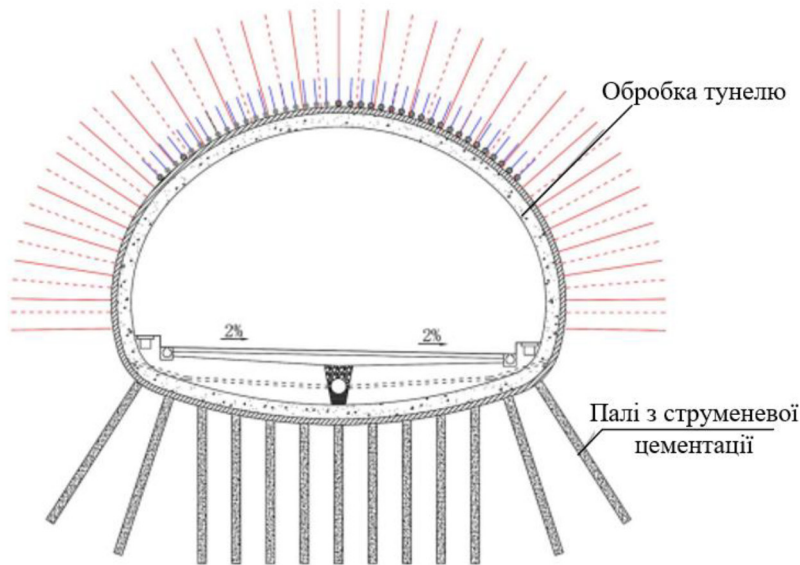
Схема зміцнення лесоподібних ґрунтів основи тунелю (м. Ланьчжоу, провінція Ганьсу, Китай) ґрунтобетонними палями [10]
